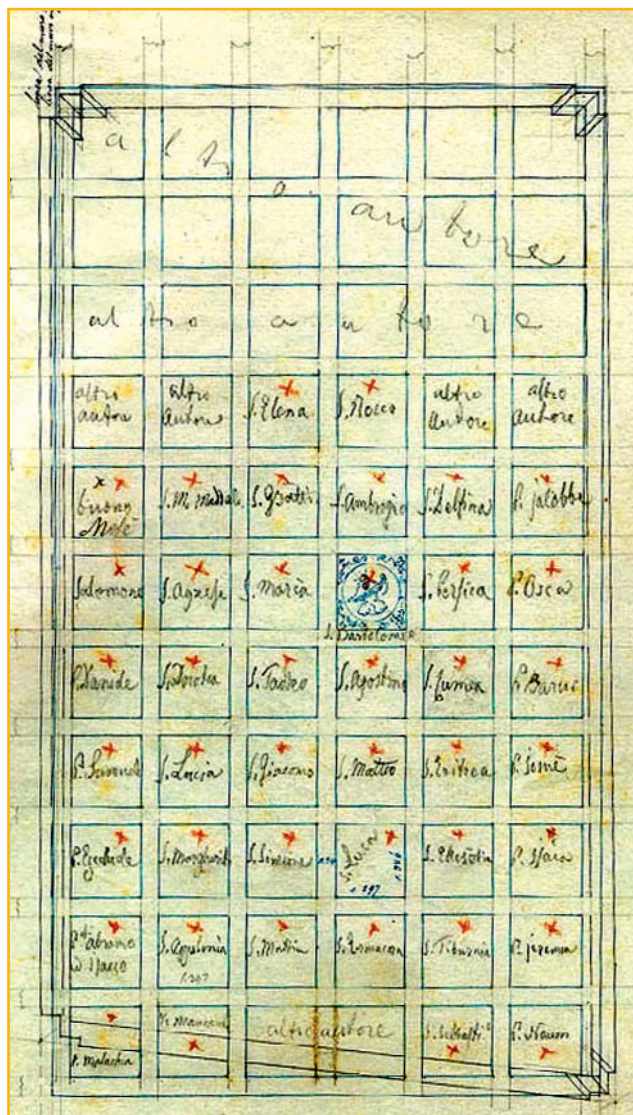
Stato del soffitto nel 1858 e disposizione originaria delle figure
